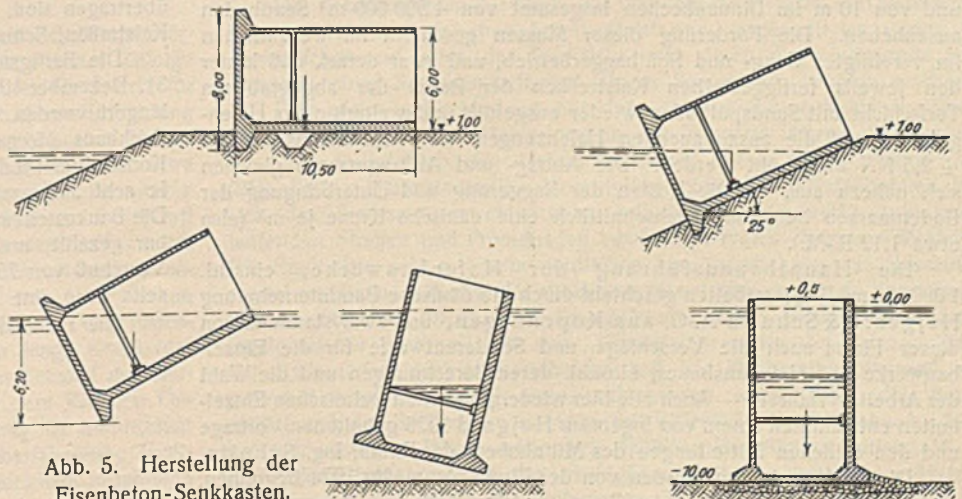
Herstellung der Eisenbeton-Senkkasten.
